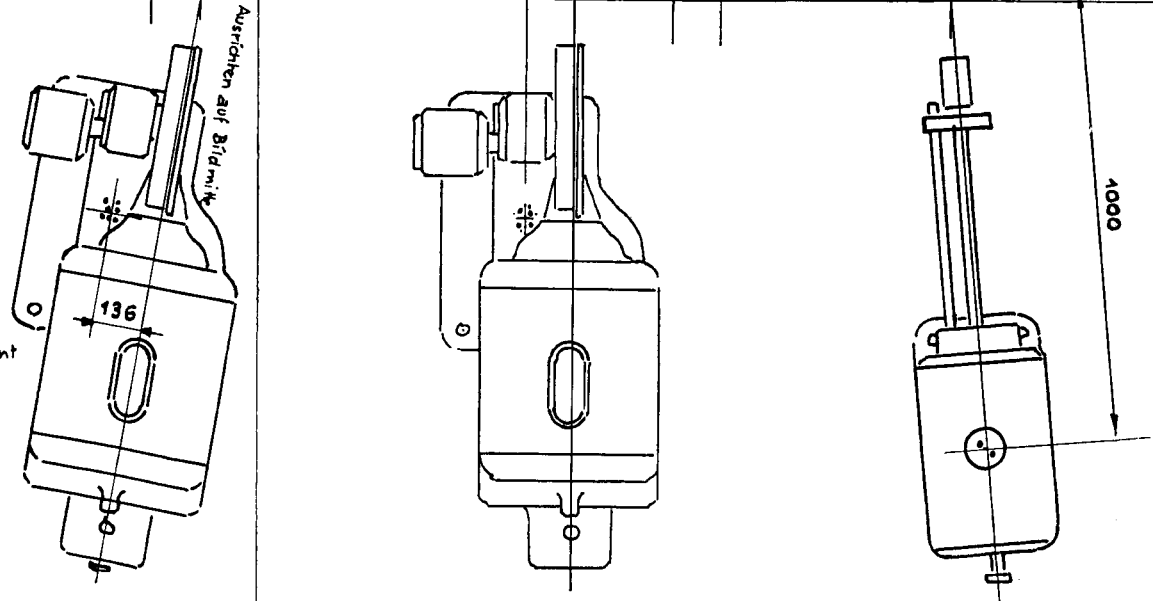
Einbauplan für 2 Bauer-B 6-Projektoren mit Hochleistungslampe HI-75 und für 1 Bauer-Dia-Projektor
